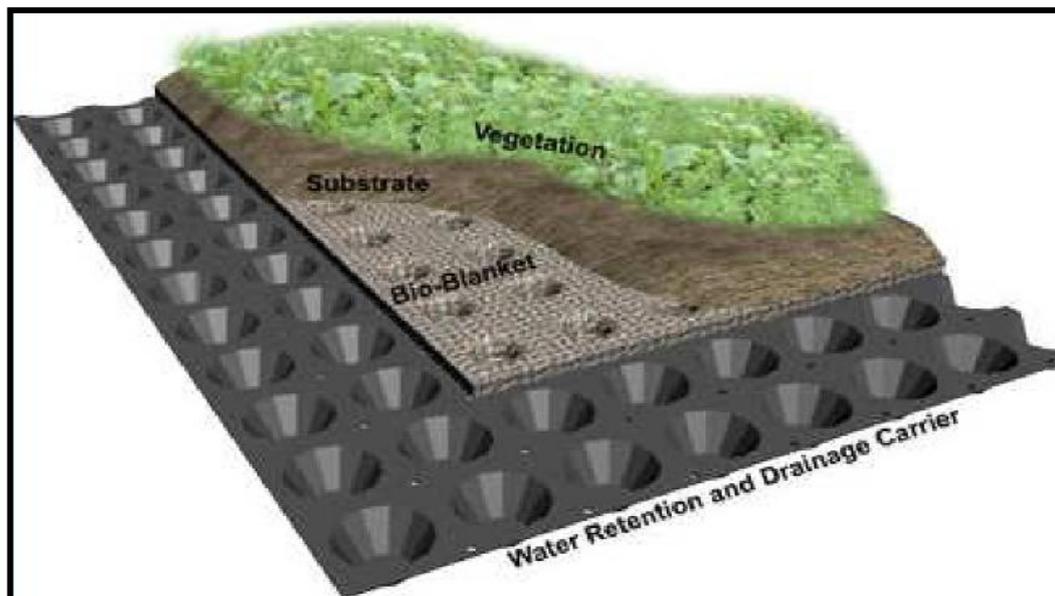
Esquema tridimensional de detalhamento de telhado verde.
